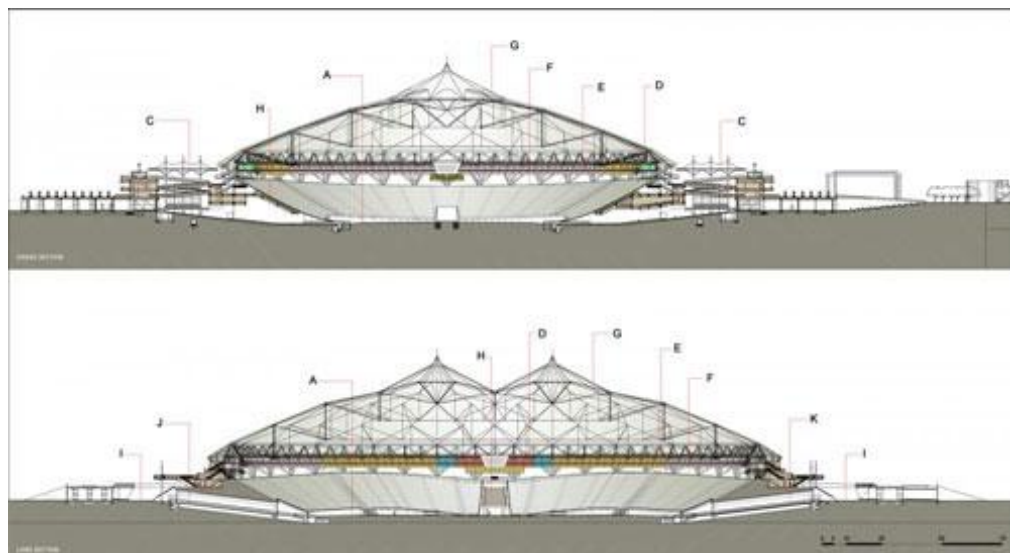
Sezione, “La Plata Stadium”, Buenos Aires, Argentina [2003]
